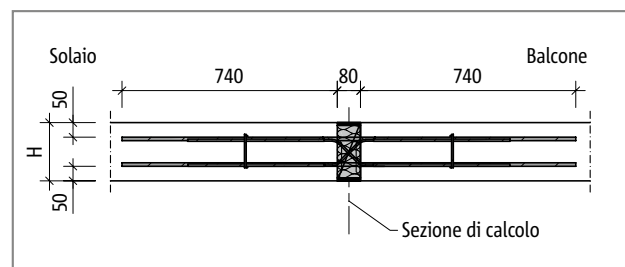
Schöck Isokorb® T tipo DL-CV2: schema statico
